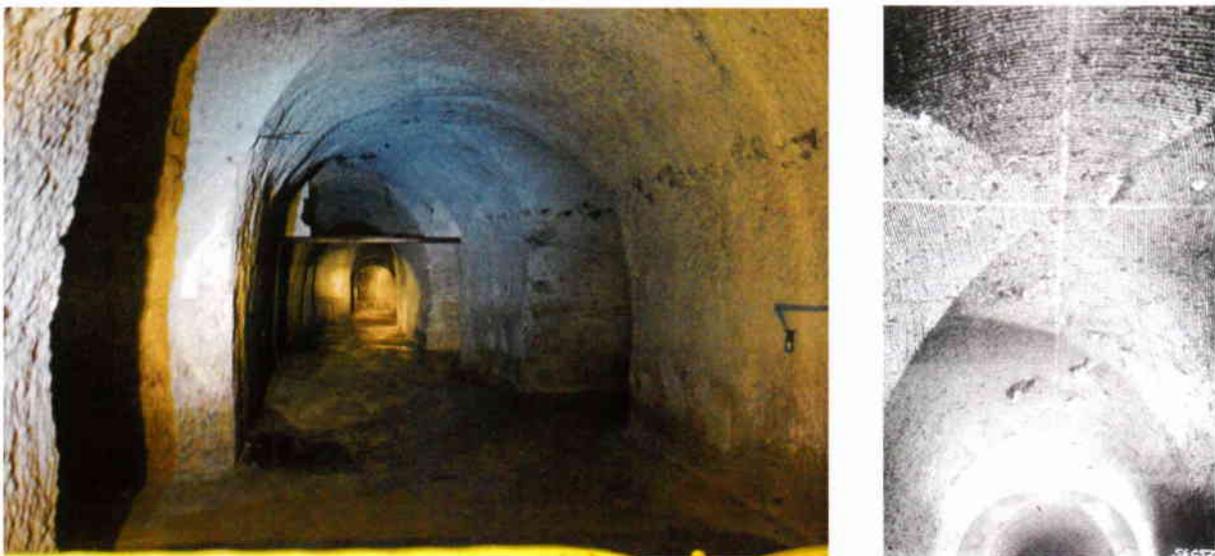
A gauche : piliers tournés de part et d'autre d'une galerie souterraine (photo B. Escaich). A droite : croisée d'arêtes au croisement entre deux galeries.
